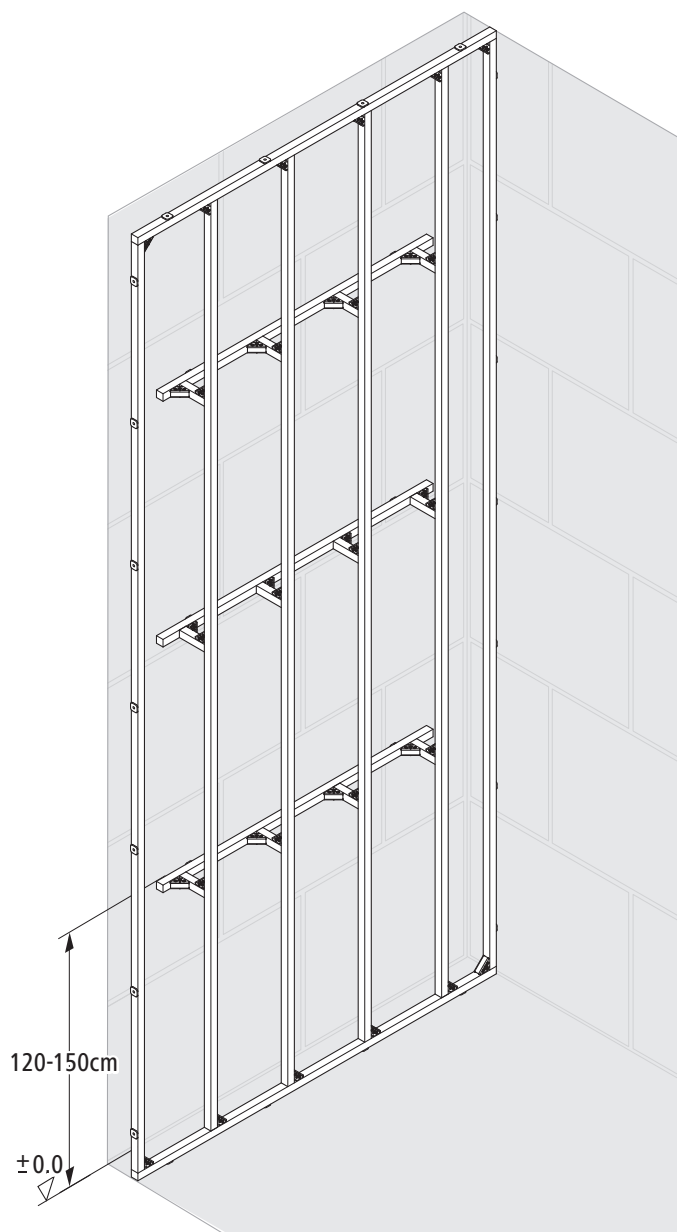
Dimensions de montage cadre de montage à hauteur du local, fixation sur le mur de soutien
